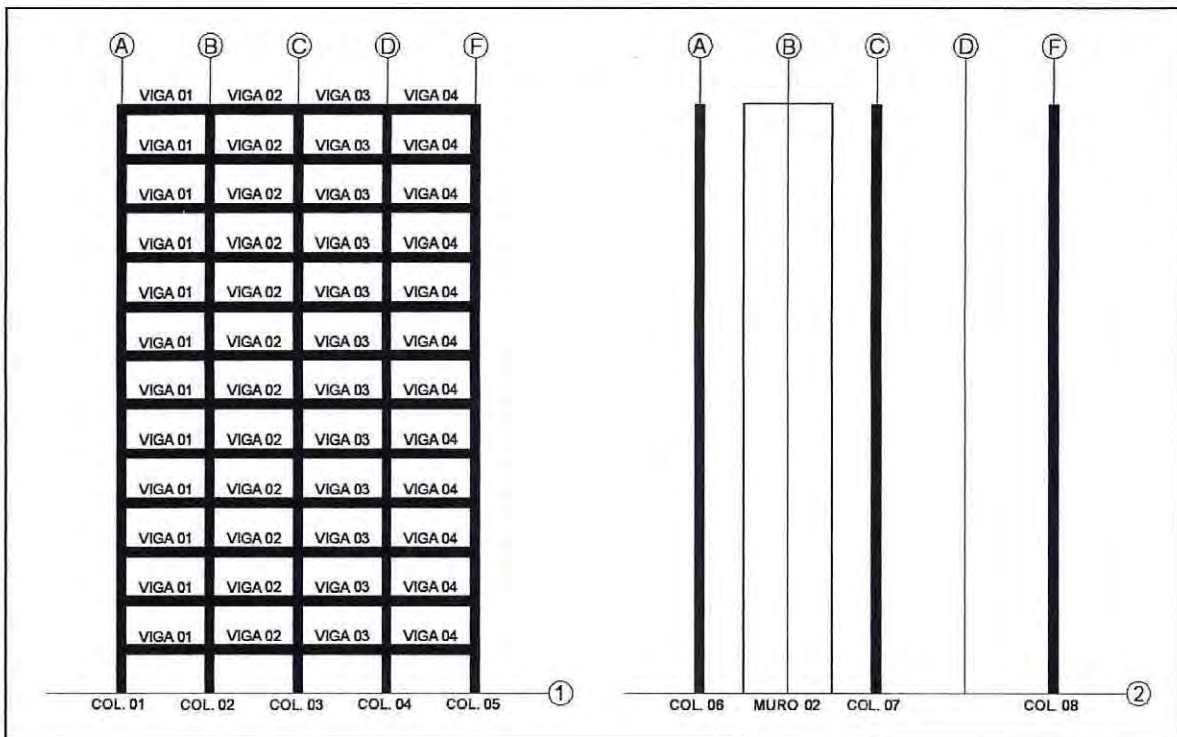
Distribución de las vigas y columnas en los ejes 1 y 2 en dirección X.
